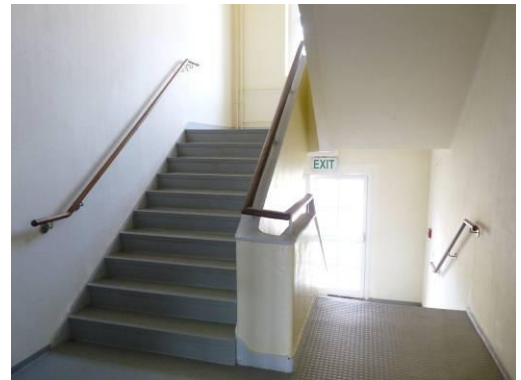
und Abbildung 5: Fassadenausschnitt Gebäude 2005 und Treppenaufgang mit Handlauf im Gebäude 2007
